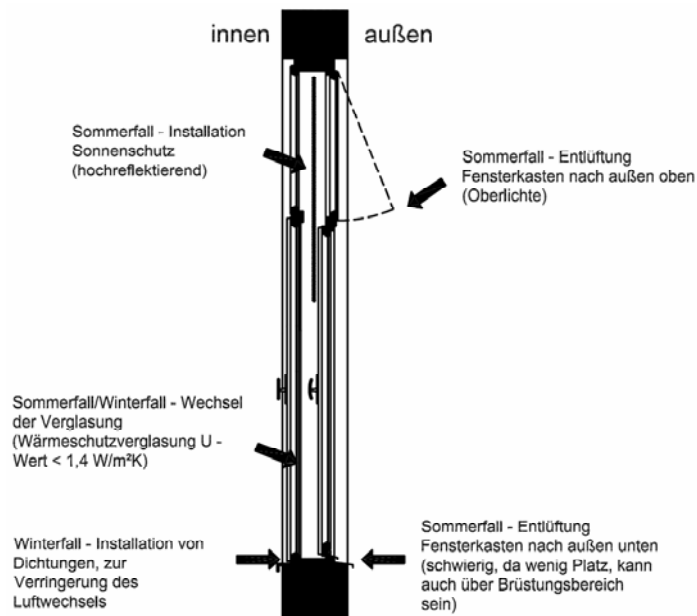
Interventionsmöglichkeiten in einem bestehenden Kastenfenster zur thermischen Verbesserung – Darstellungen in einem Schemafensteranschnitt, [Quelle: REIM, T. (2006)]
